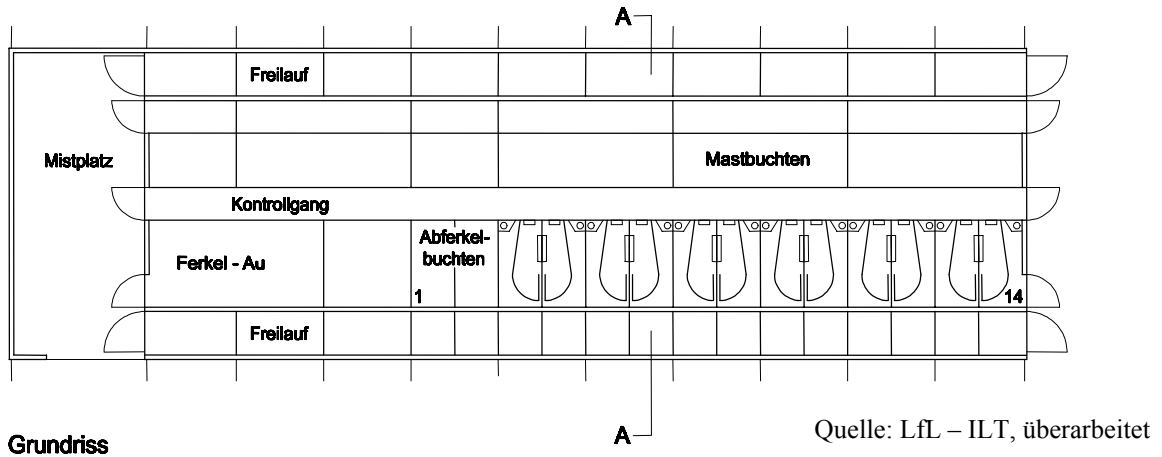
Grundriss Zuchtsauen- / Maststall, Betrieb B
